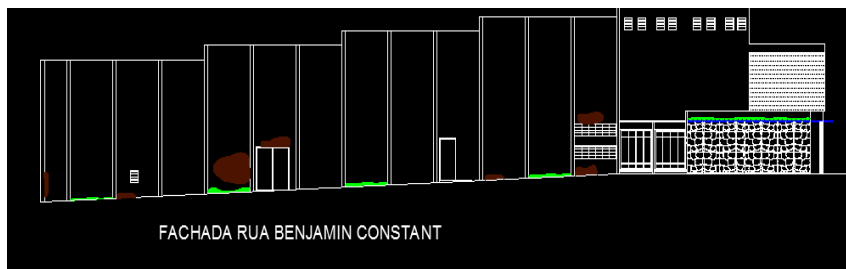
imagem da fachada lateral do prédio na face Norte Rua Benjamin Constant.
